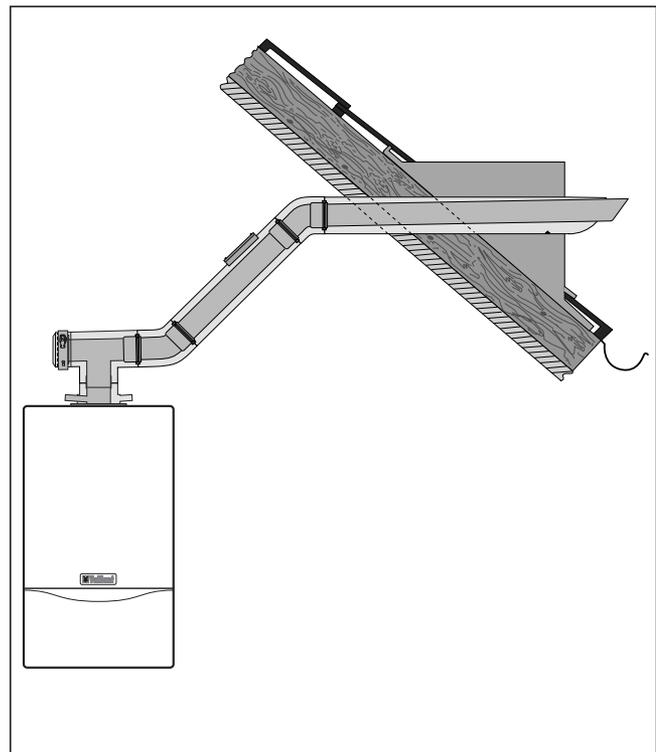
Montagebeispiel: Waagerechte Dachdurchführung
